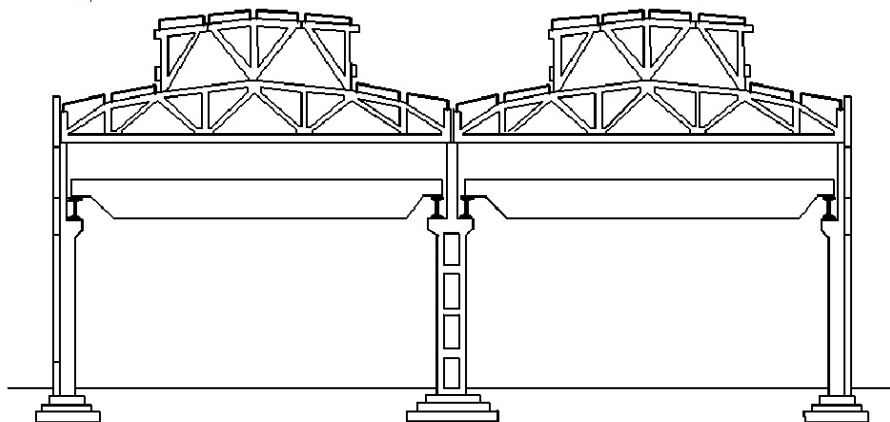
Поперечна рама двопролітної промислової будівлі
